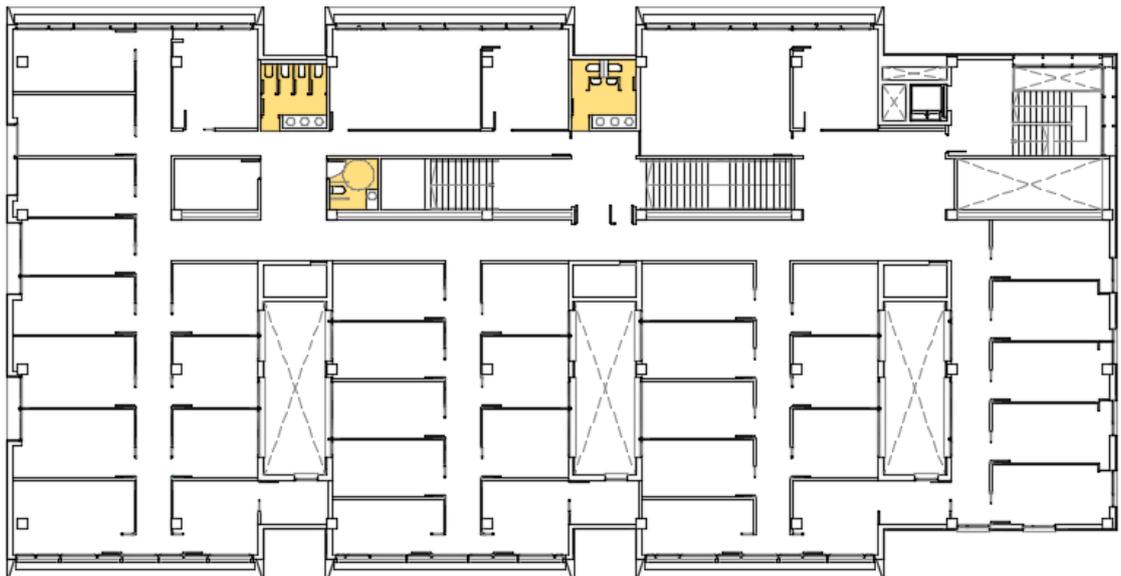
Situación Aseos en Planta Segunda. Figura extraída del plano 54.
